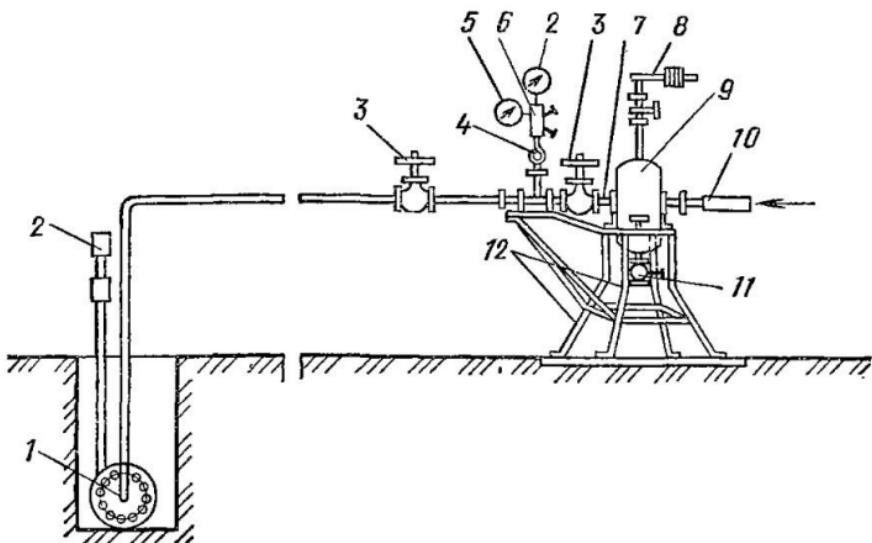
Присоединение компрессора к испытываемому трубопроводу
